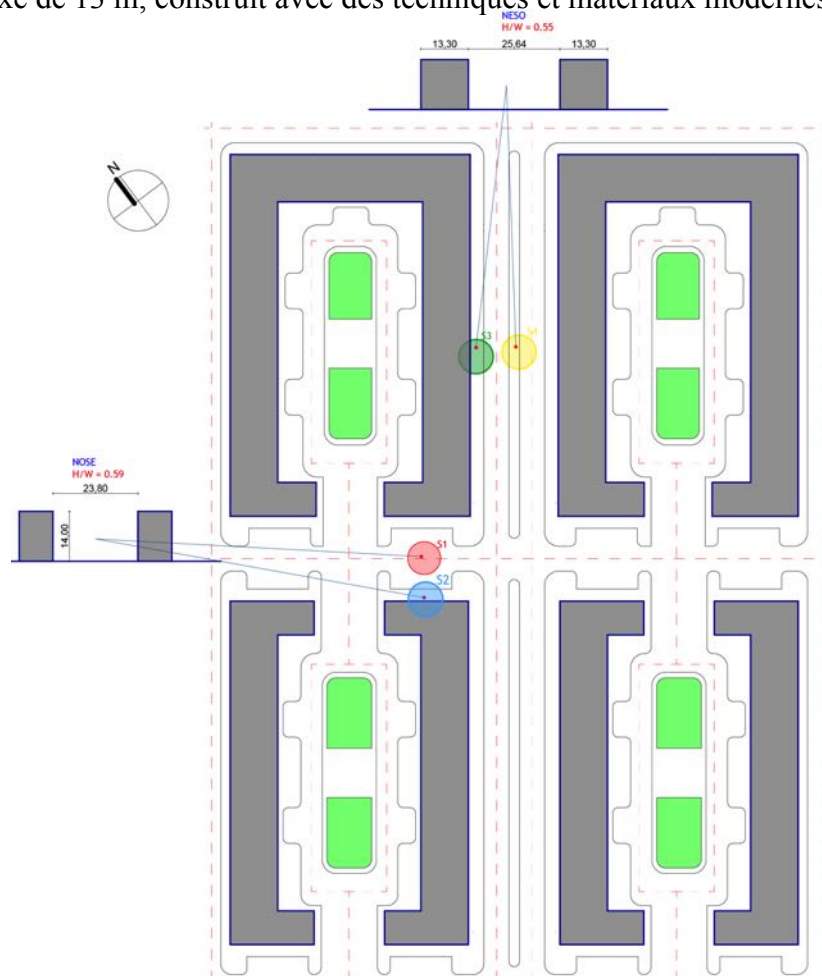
Plan du tissu N°3 457 logements collectifs (Source : Auteur).
